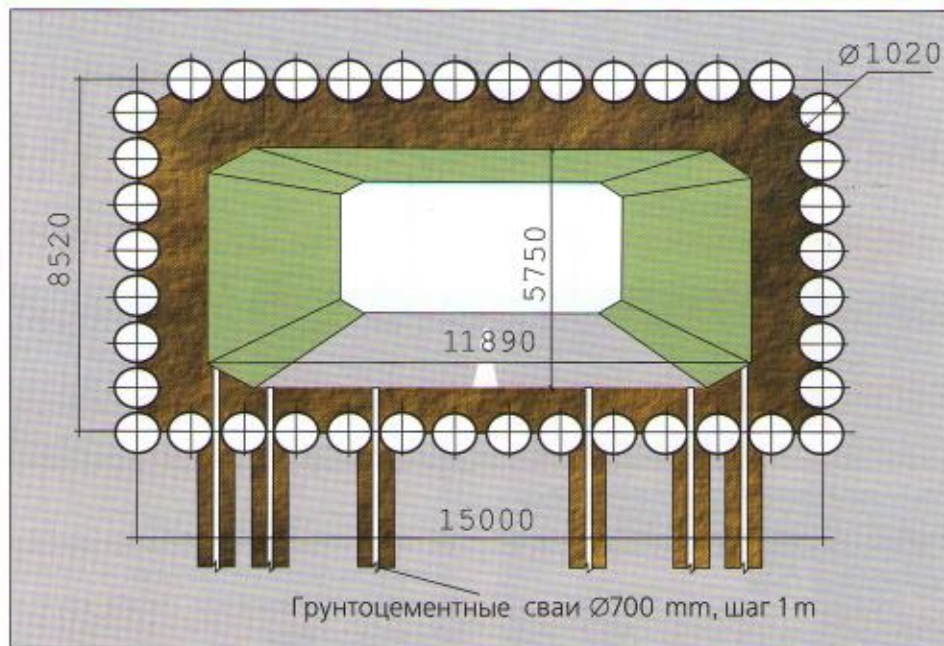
Грунтоцементные сваи в основании лотка тоннеля
